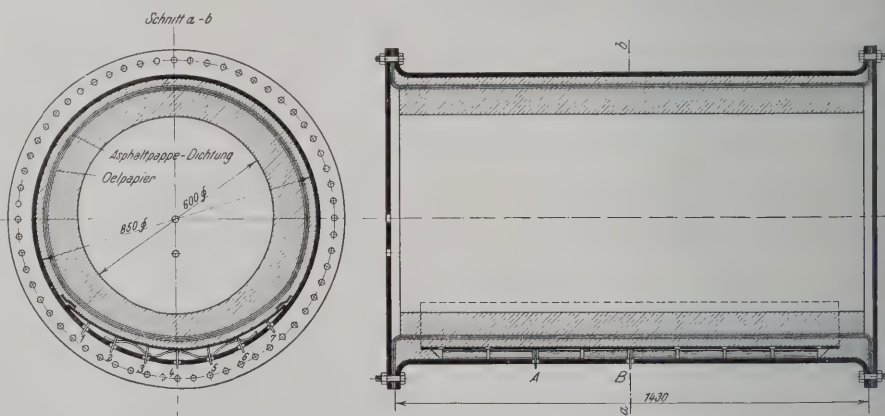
I. Versuch mit einer elastischen Dichtung bei nachgiebiger Unterlage.
